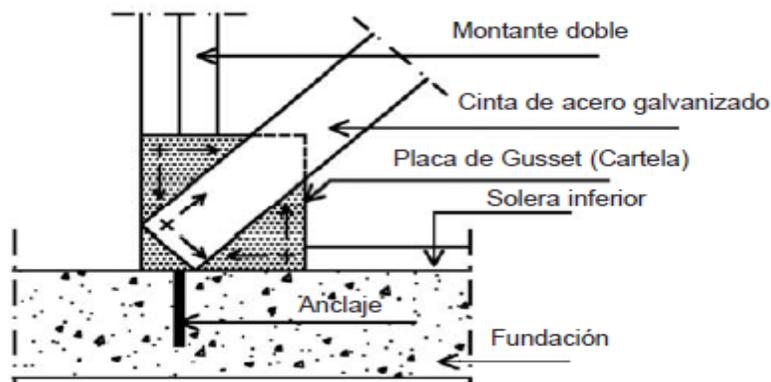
Fijación de las diagonales en los paneles con cartela.
